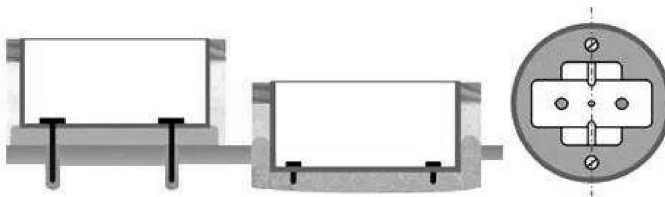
Общий вид установки подрозетника в бетонное основание
